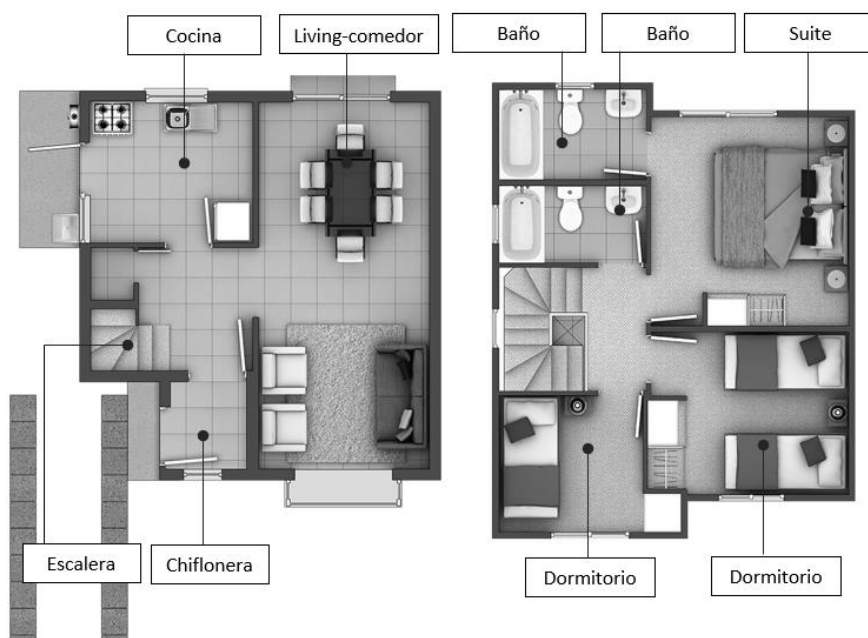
Plantas 1 y 2° nivel, vivienda de 64m2
